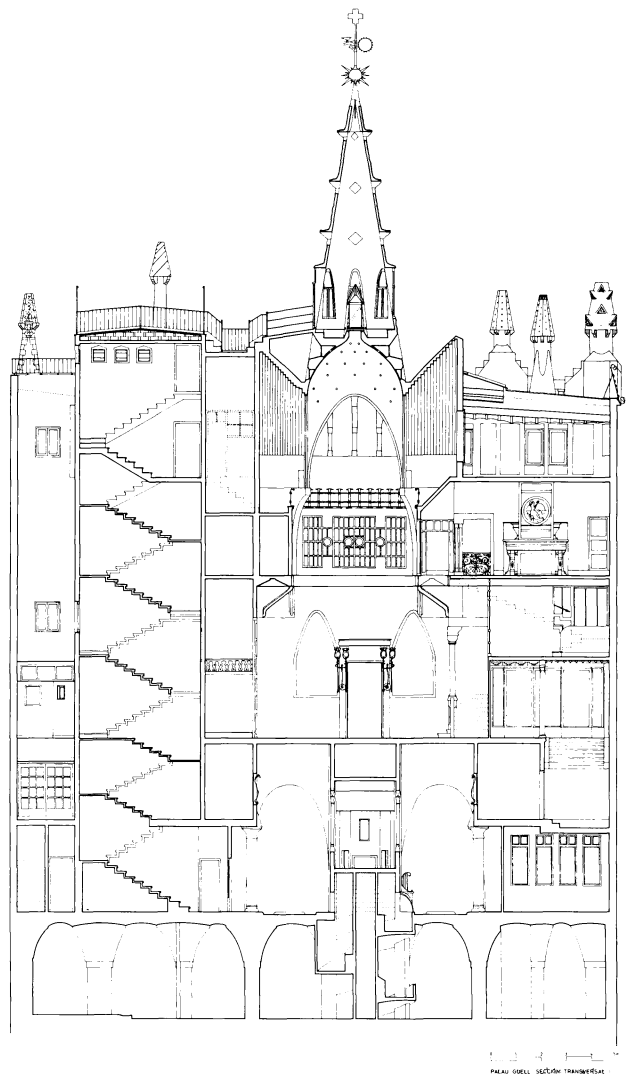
Sección transversal por la escalera de servicio y la rampa peatonal de acceso al subterráneo. (Dibujo Joan Surís).
